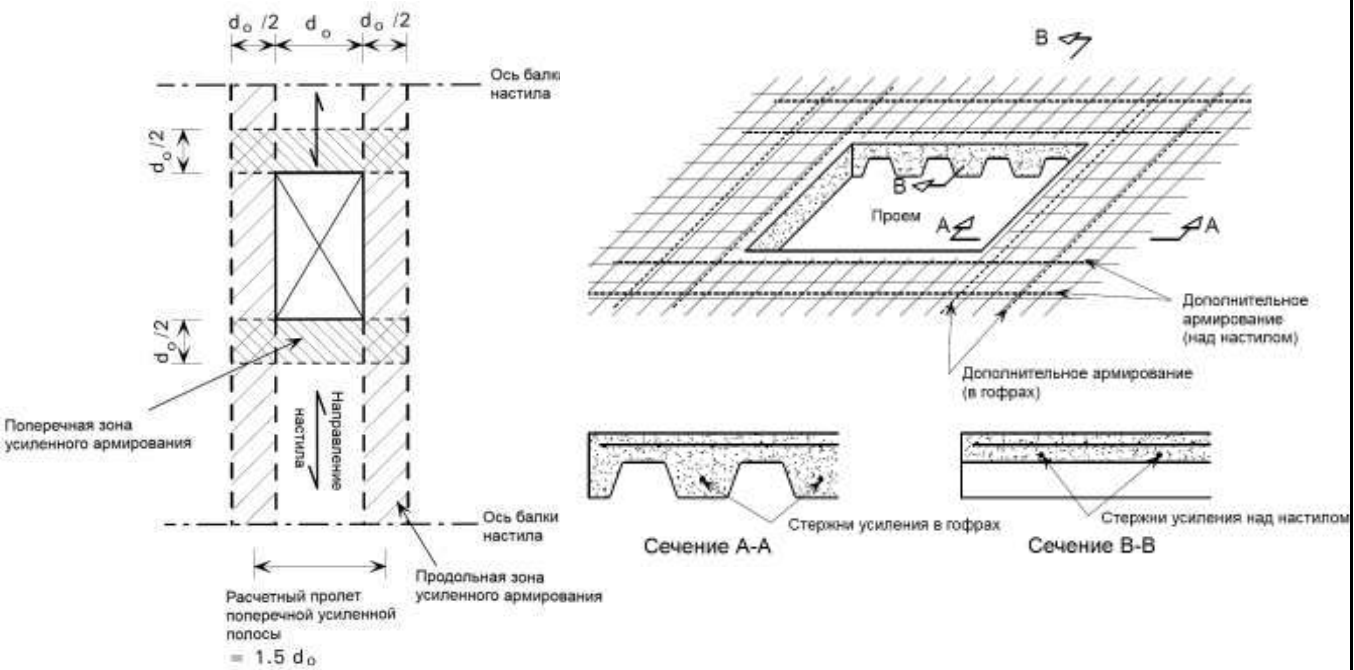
Расчетная схема и соответствующее армирование вокруг проемов средних размеров
